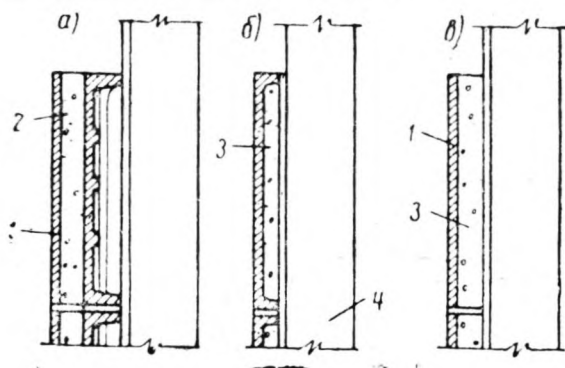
Схемы конструкций панелей стен отапливаемых производственных зданий
